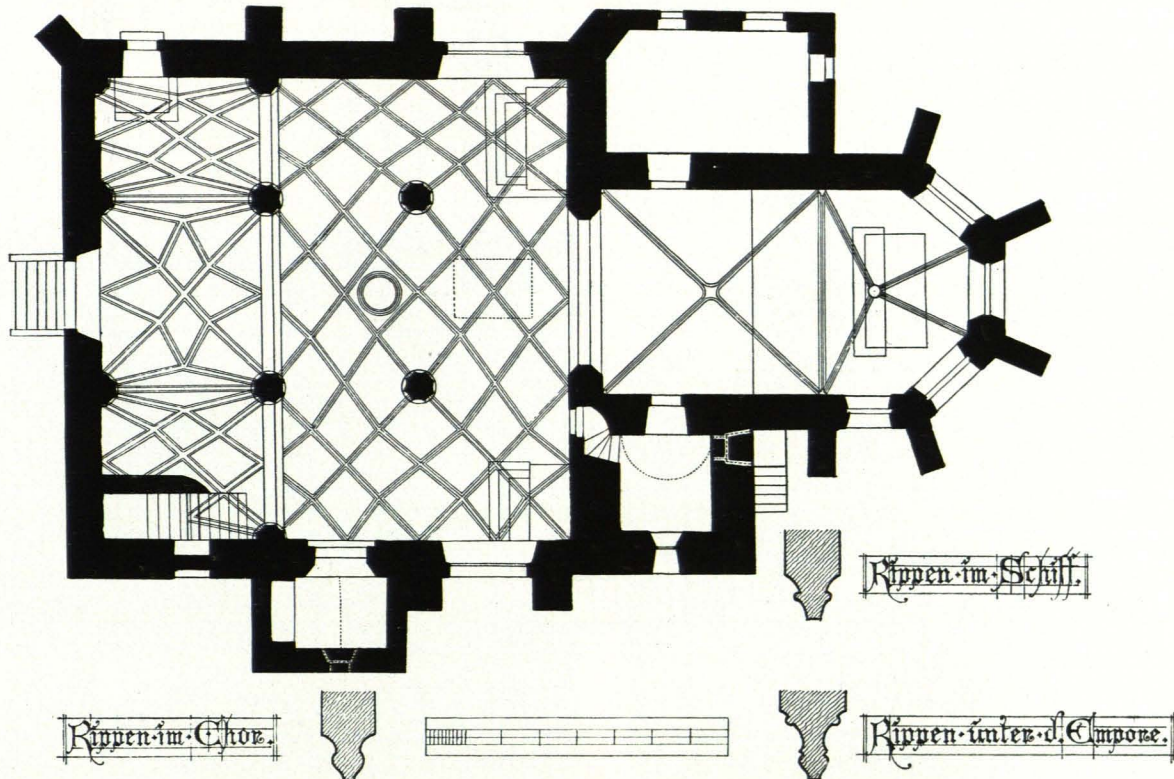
Klein-Pöchlarn, Pfarrkirche, Grundriß 1 : 200 (S. 158)
